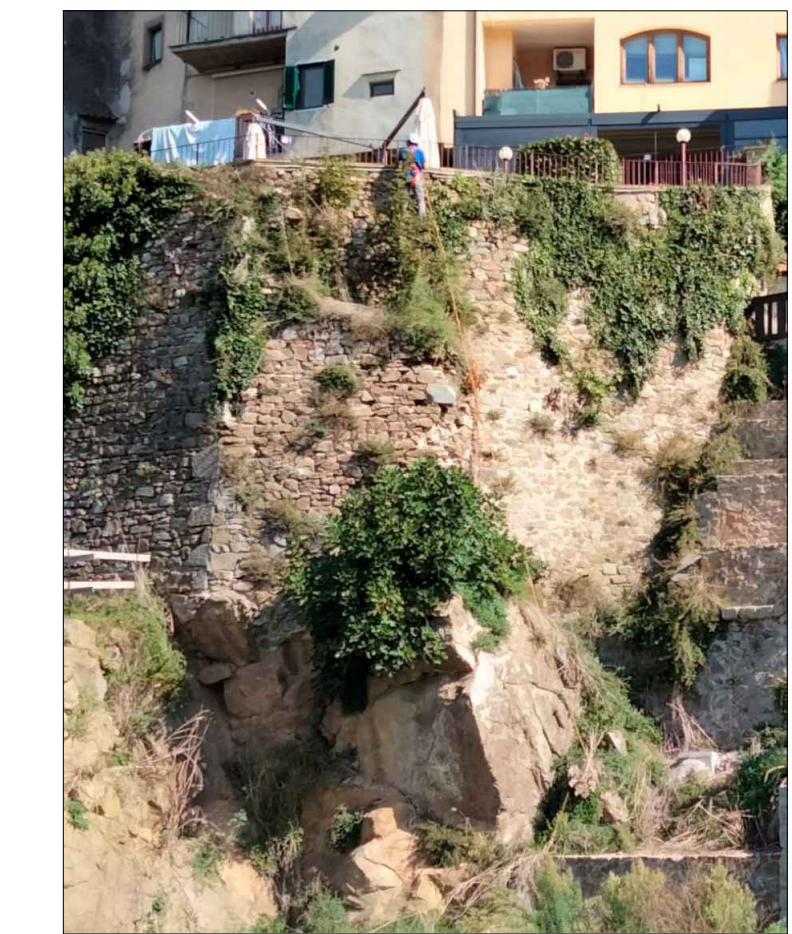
Fase di realizzazione del profilo sismico - vista su parete
